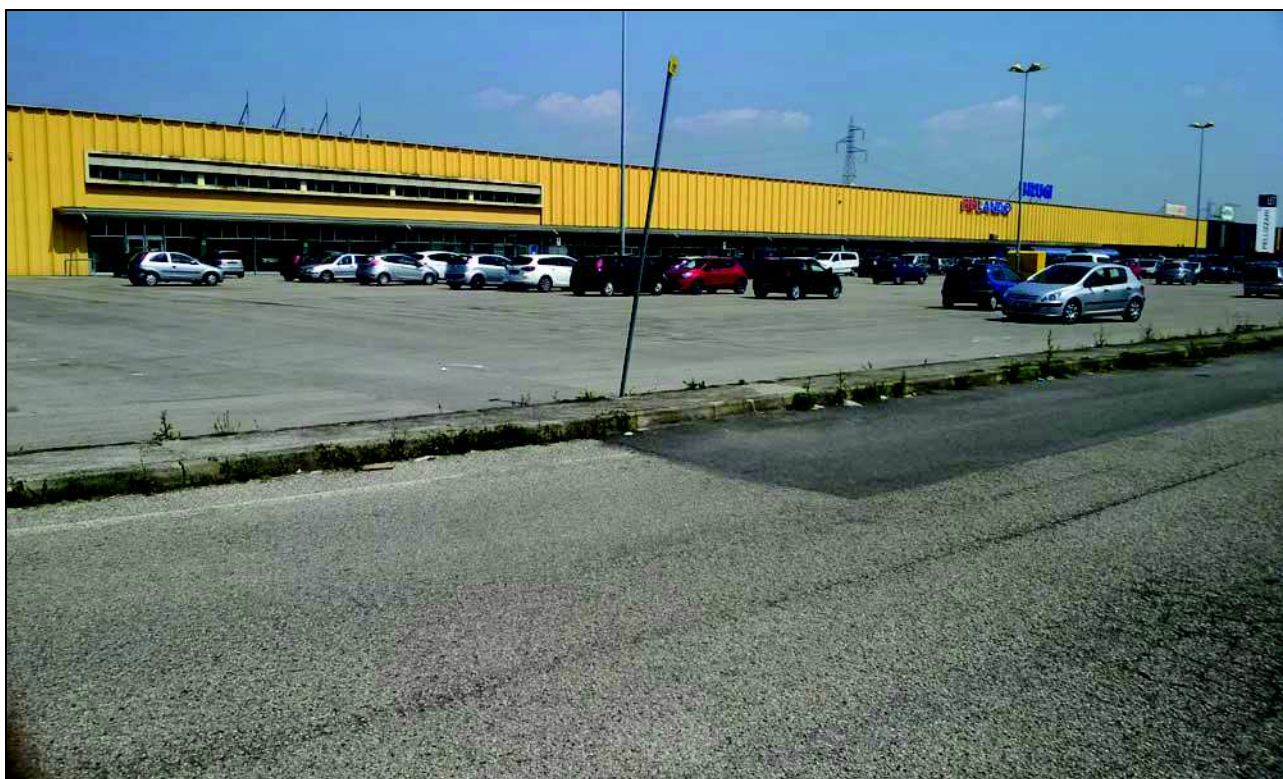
Prospetto sud dell'edificio commerciale di proprietà della ditta F.Ili Lando S.p.A.
